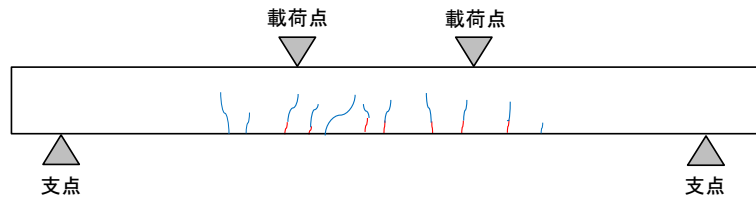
OPC 製 RC 梁のひび割れ発生状況
